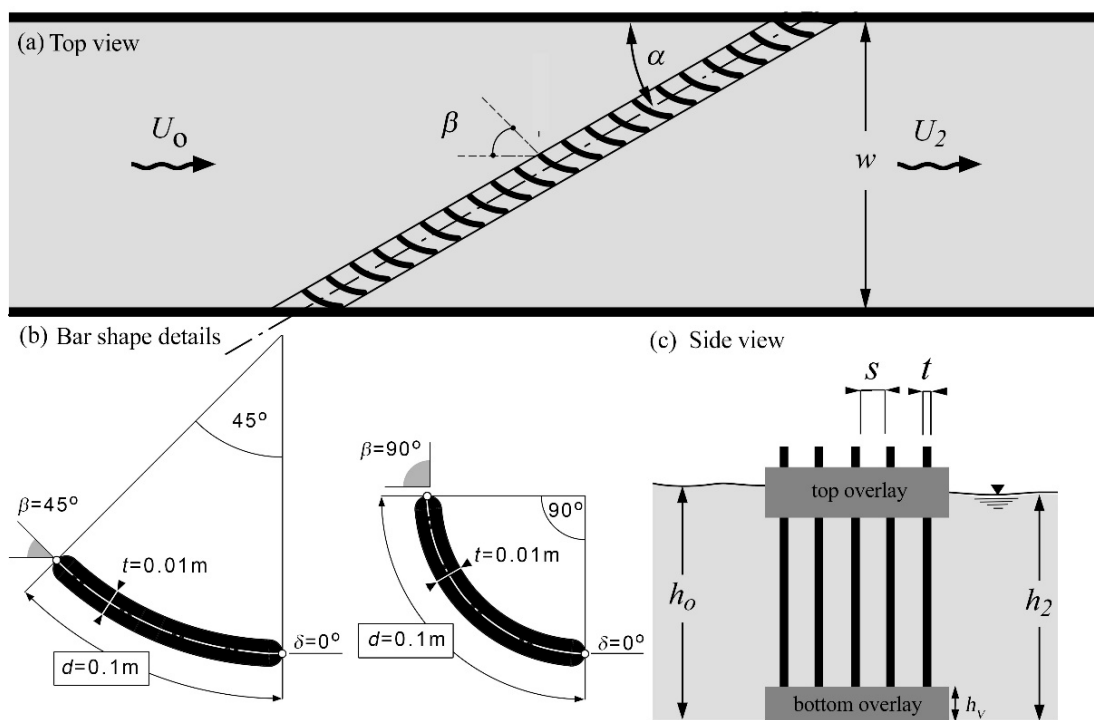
(a) Situationsplan der Anordnung für die Modellversuche (Massstab 1:2), (b) gebogene Stabformen im Grundriss und (c) seitliche Ansicht des Leitreechens mit Sohl- und Tauchleitwand.
